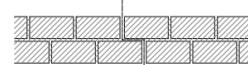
Junta de movimiento con solape. Esquema en planta
